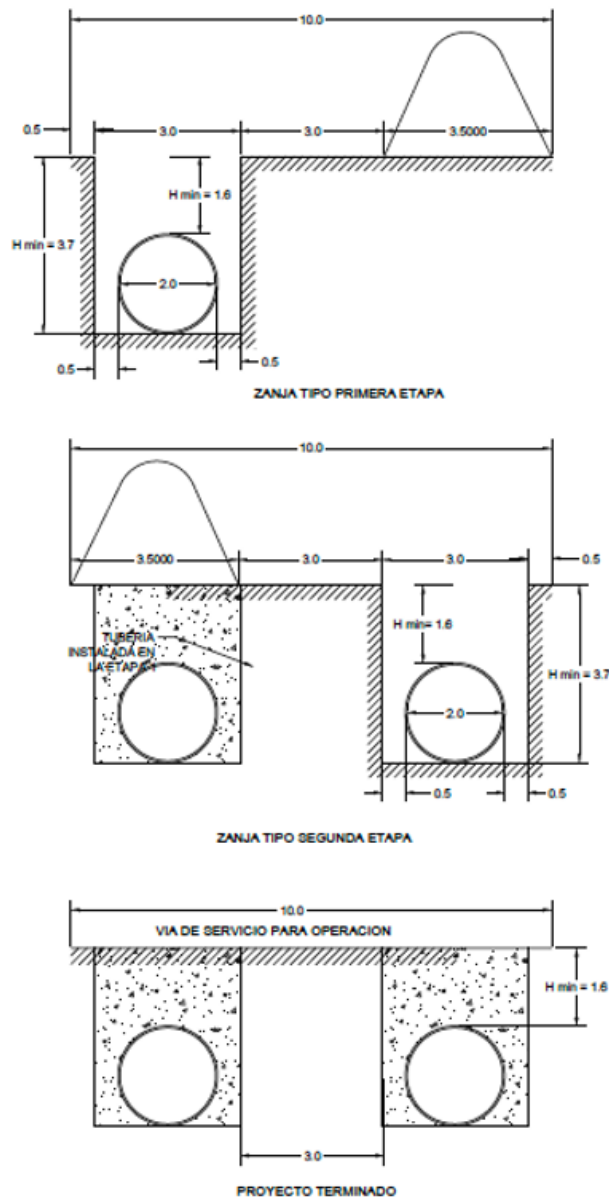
Esquema de instalación de las tuberías de conducción
